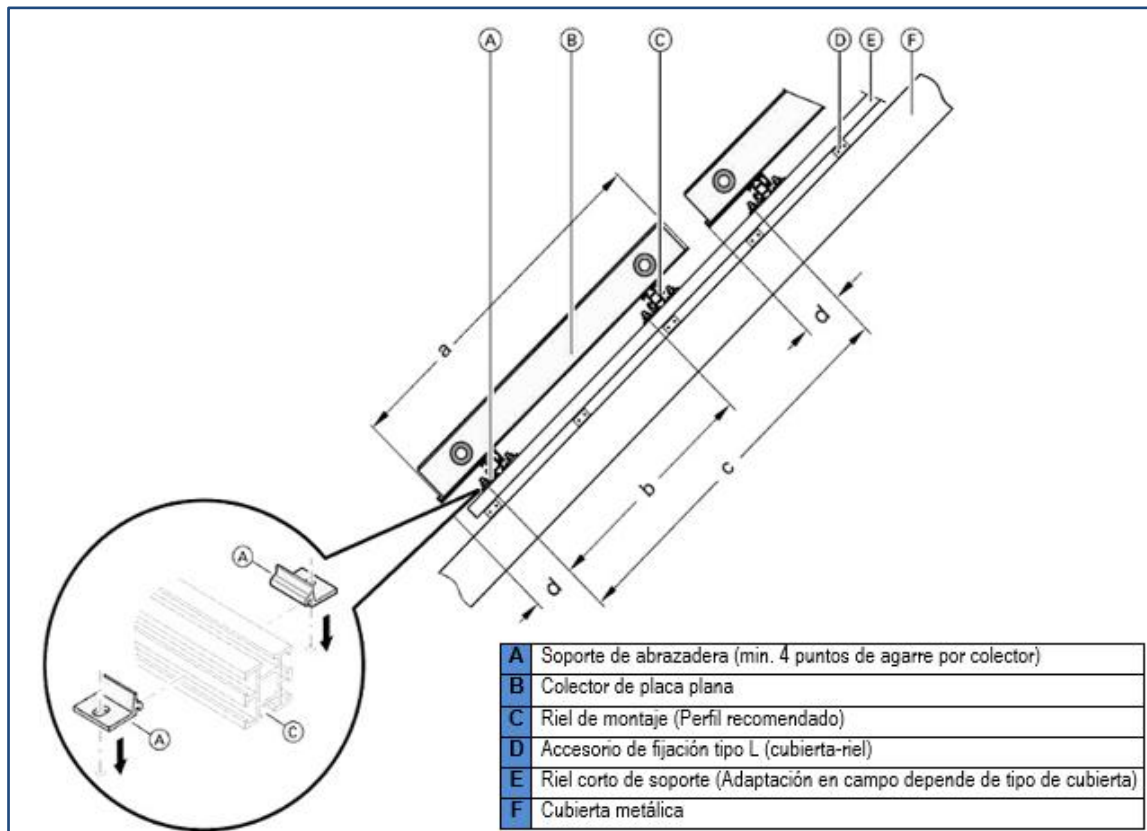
Sistema de montaje recomendado por fabricante para cubierta inclinada
